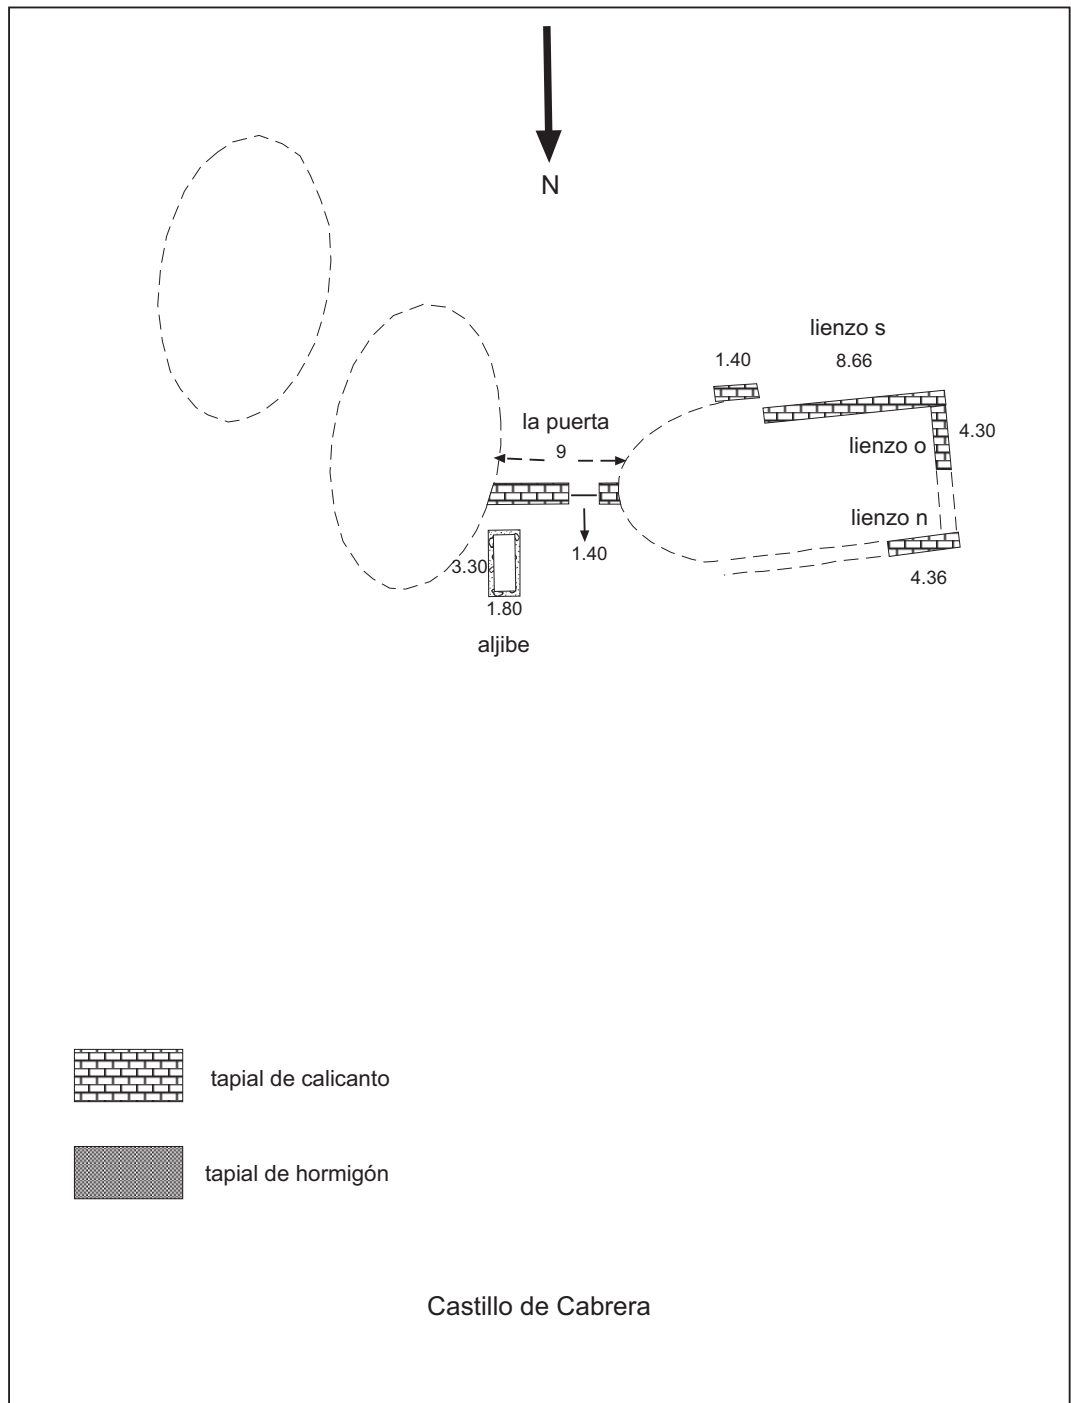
Planta simple del castillo de Cabrera con sus técnicas constructivas.
